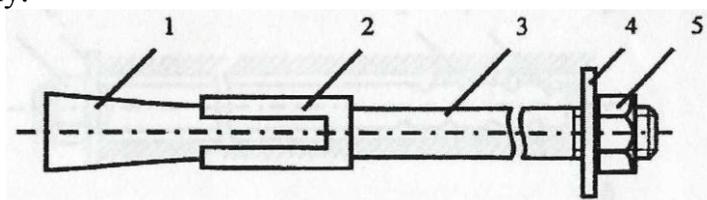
Конструкция металлического клинораспорного анкера с двухперой гильзой
